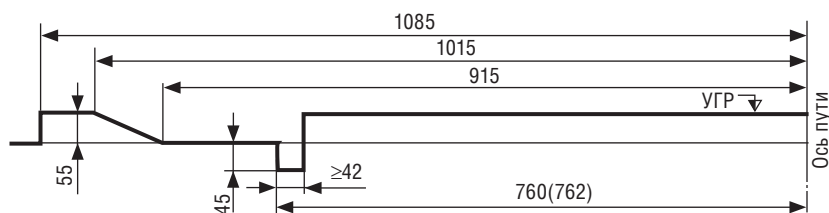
Нижнее очертание габарита С для двойных перекрестных стрелочных переводов
